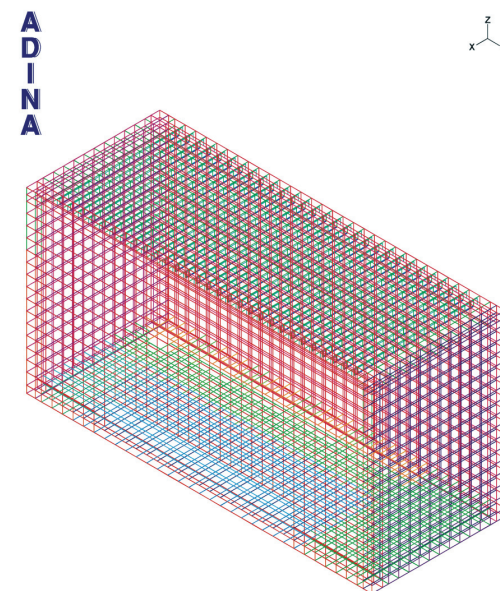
конечно-элементная аппроксимация арматурных стержней железобетонной конструкции помещения бокса сепараторов пара
